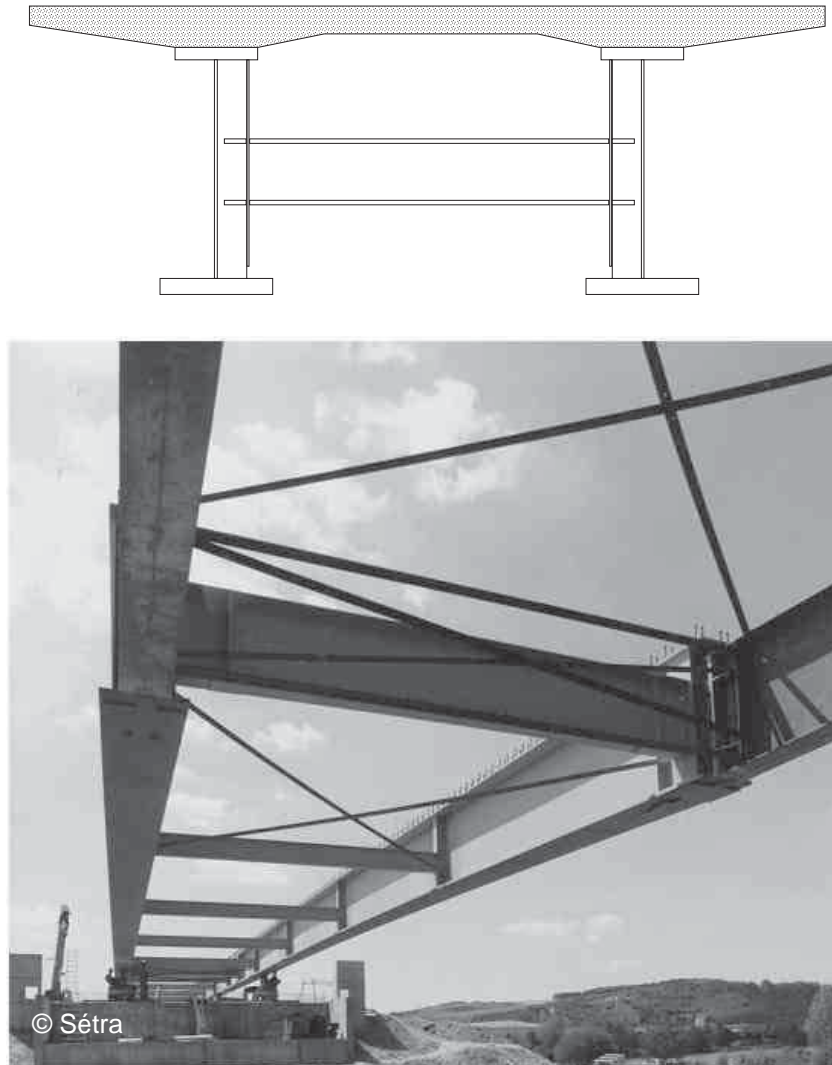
Section transversale courante d'un pont bipoutre mixte
